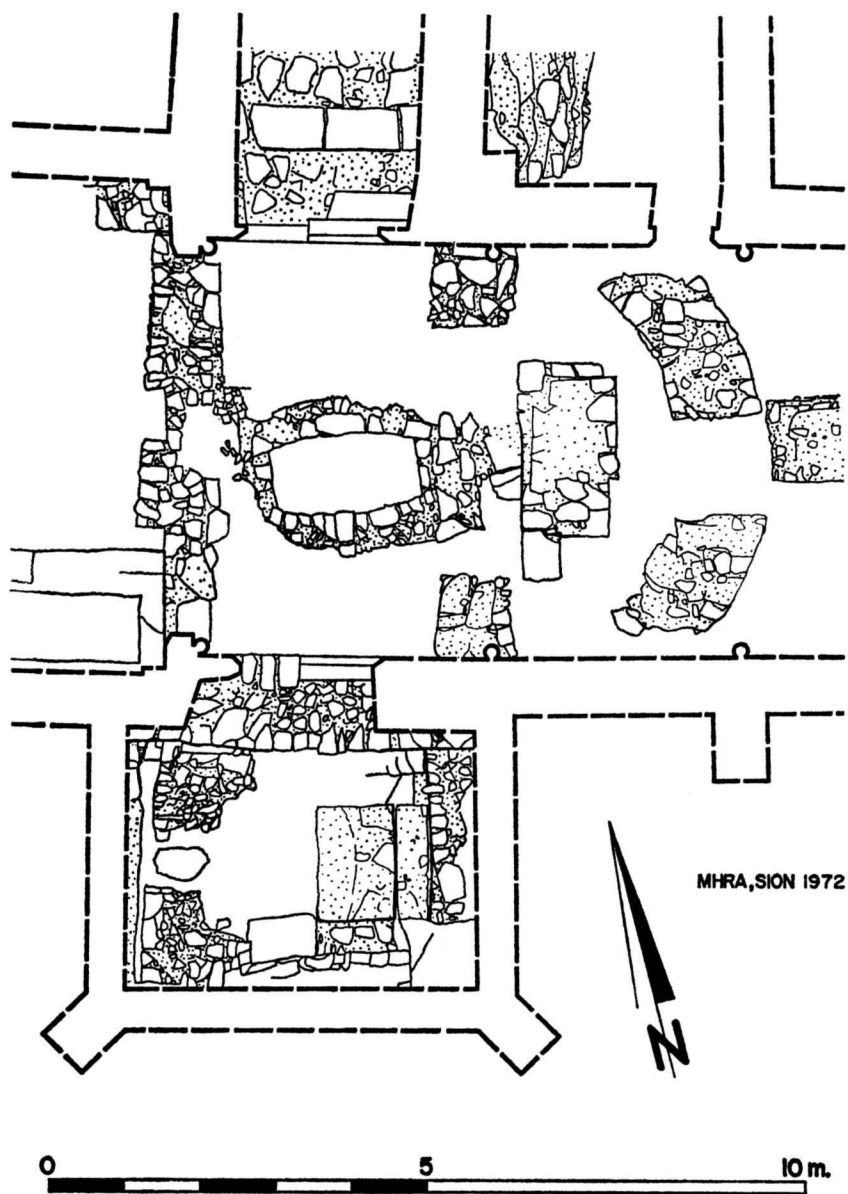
Plan des fouilles (chœur et Saint-Antoine).
